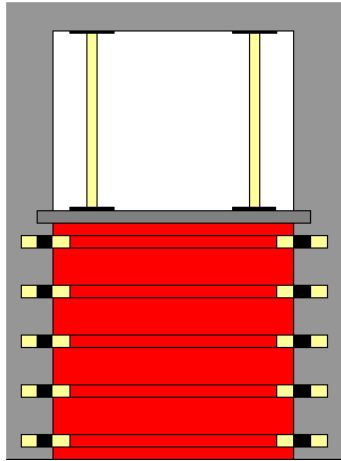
Abschlussprofil (U-Profil) mit Montagestäben
